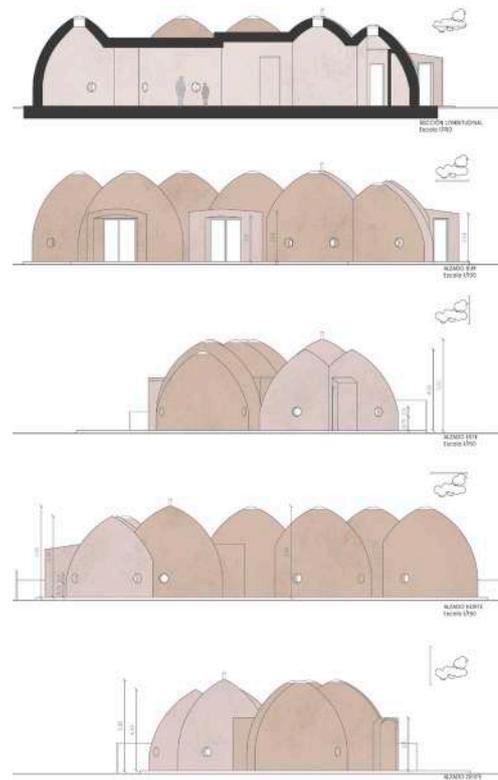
Alzados y sección. Ver anexo con documentación del proyecto.
